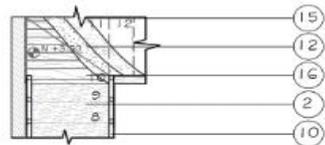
Planta de detalle 1 (Tipología 3)-Esc:1/50
